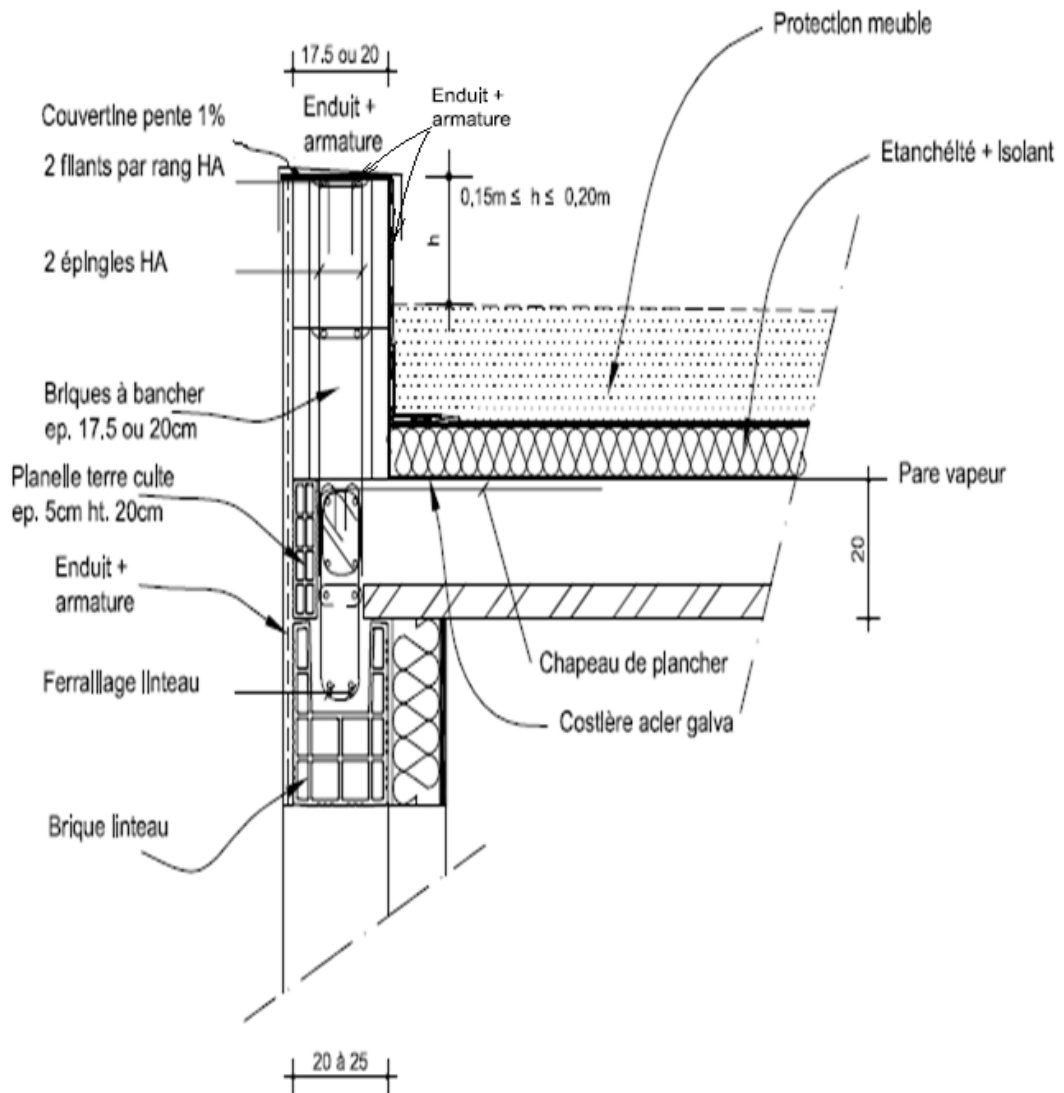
Coupe avec acrotère bas , terrasse non accessible (2)
